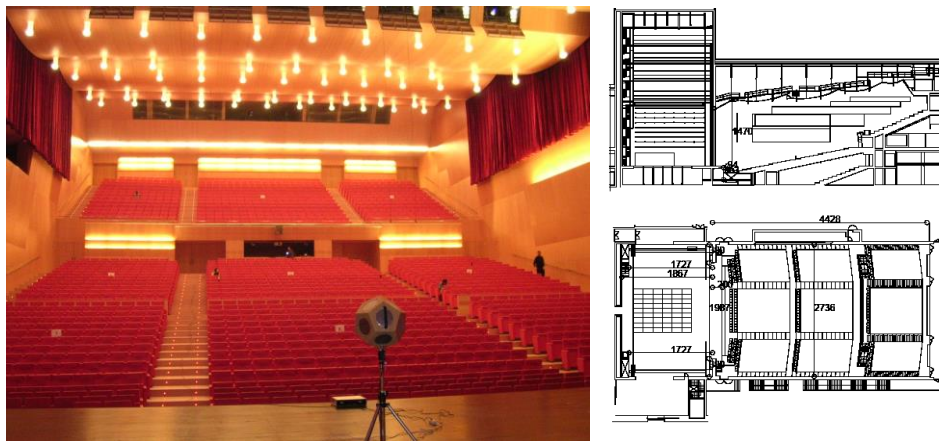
(Fotografía del Auditorio Baluarte (izda.), planos de planta y alzado (dcha.))
